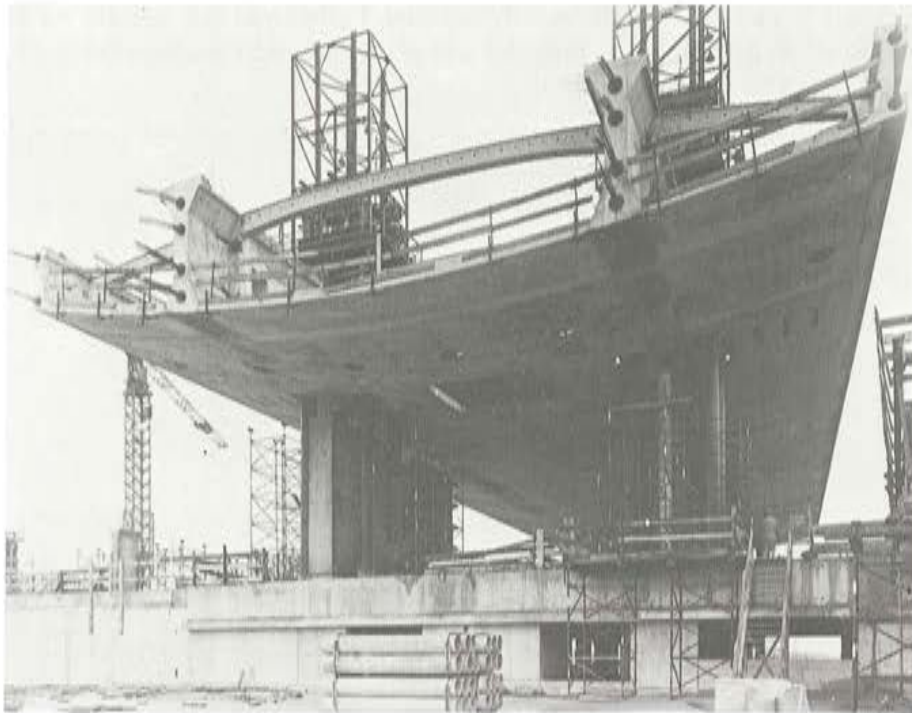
Elevación de uno de los cajones de la cubierta. (Foto Bouygues).
